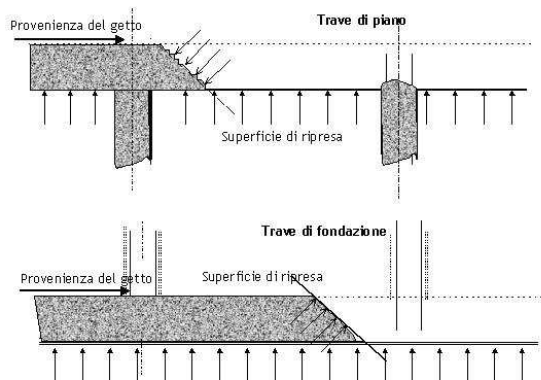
Ripresa di getto in travi di piano e di fondazione
